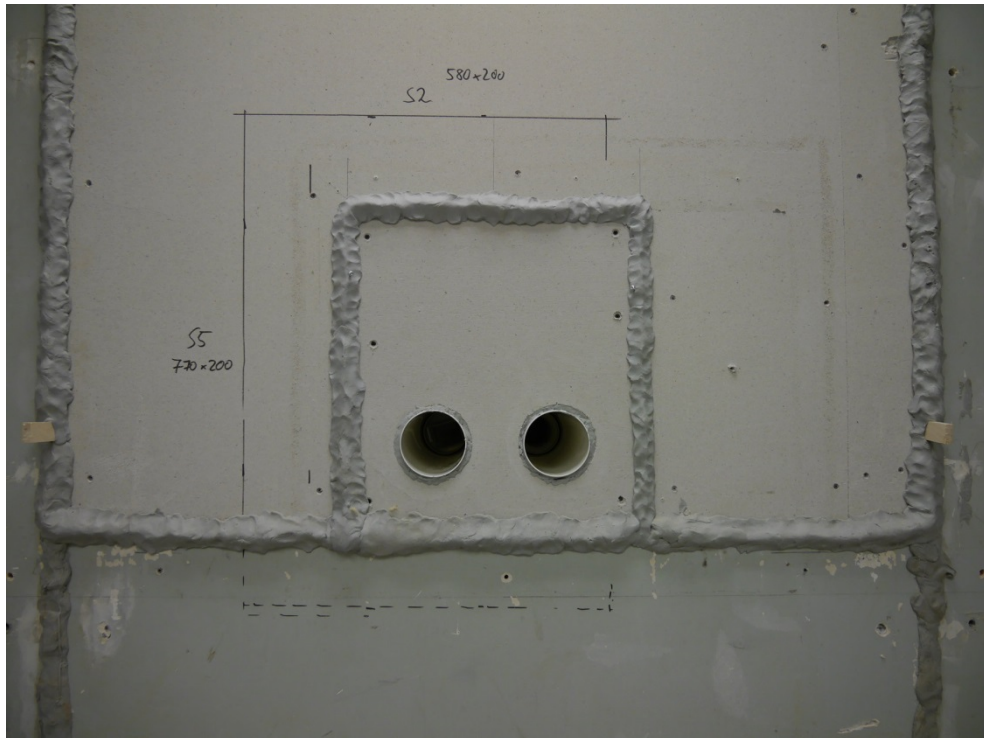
Lüftungsöffnungen außenseitig (Fortluft links, Außenluft rechts), Fassadenabschluss Edelstahlschote noch nicht montiert.
